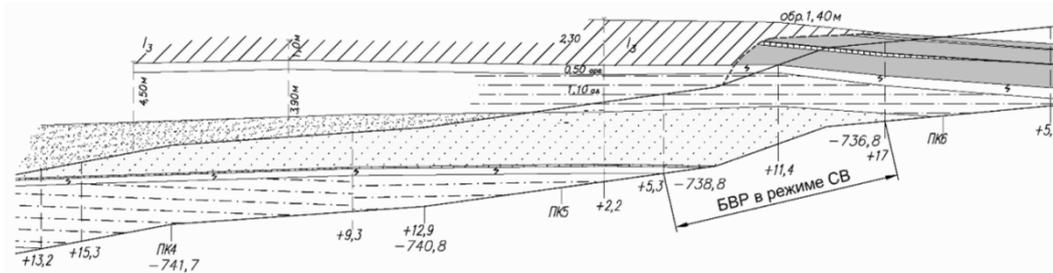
Геологический разрез по трассе вскрывающей выработки угольный пласт l_3
